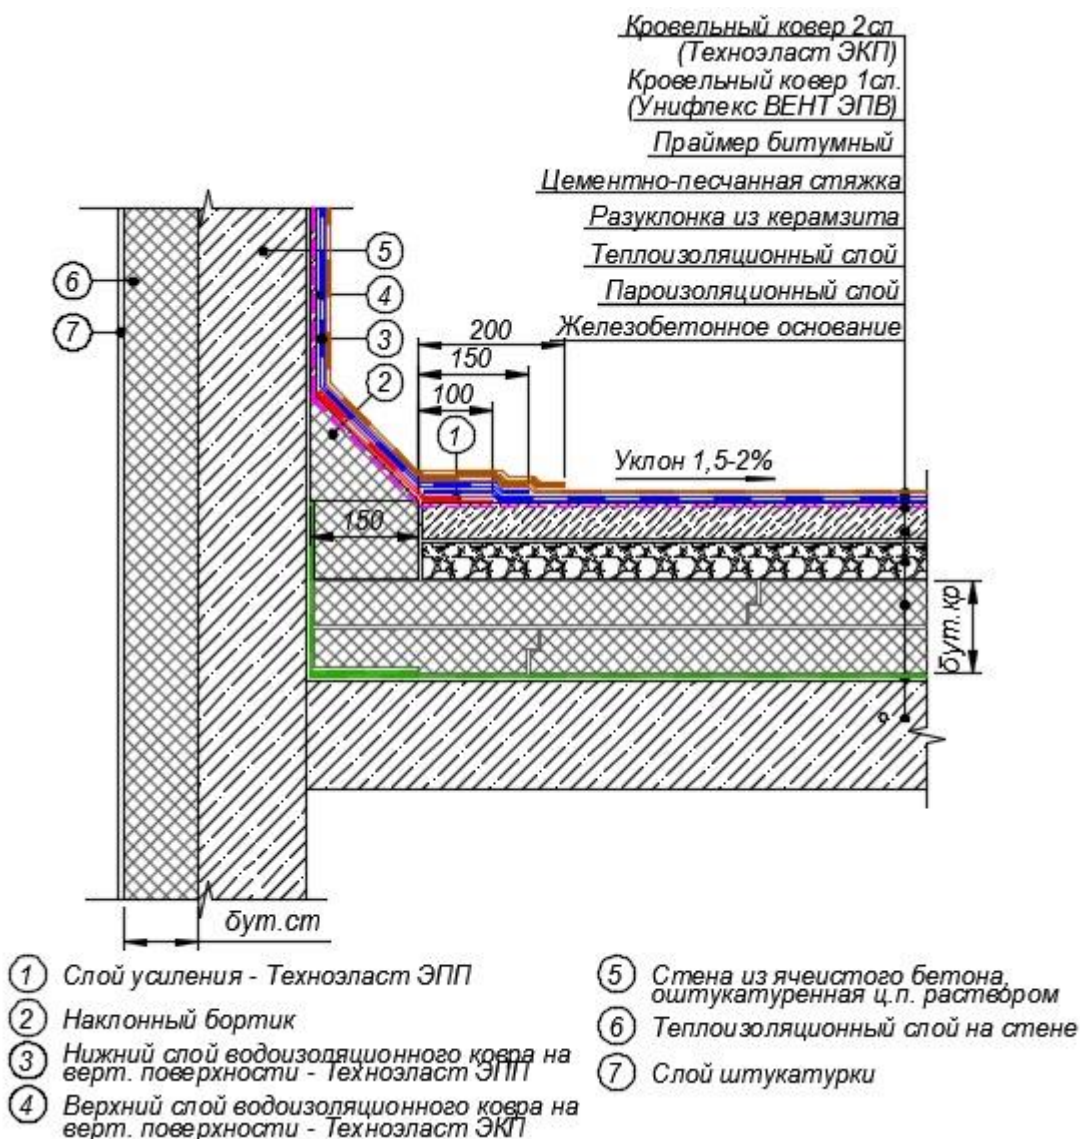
Схема примыкания кровельного ковра к парапету
